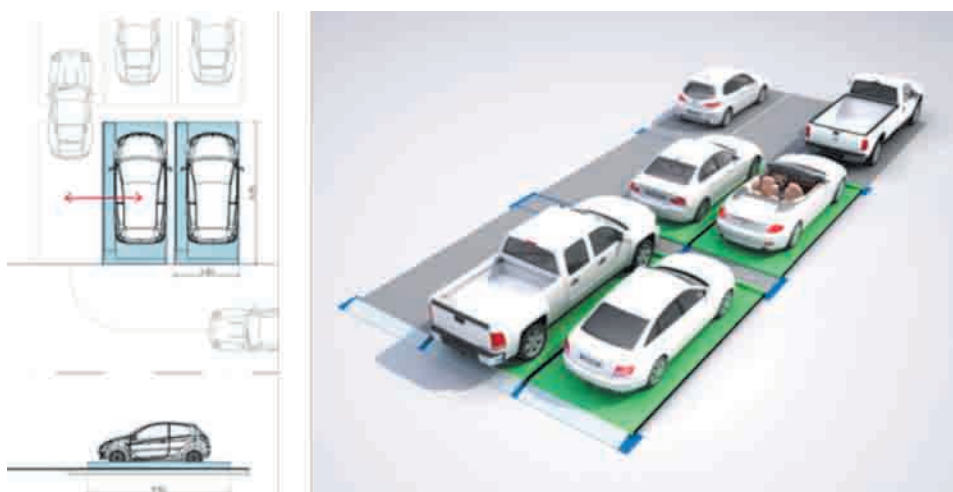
Esquemas en planta y sección de plataformas deslizantes con movimiento lateral.
